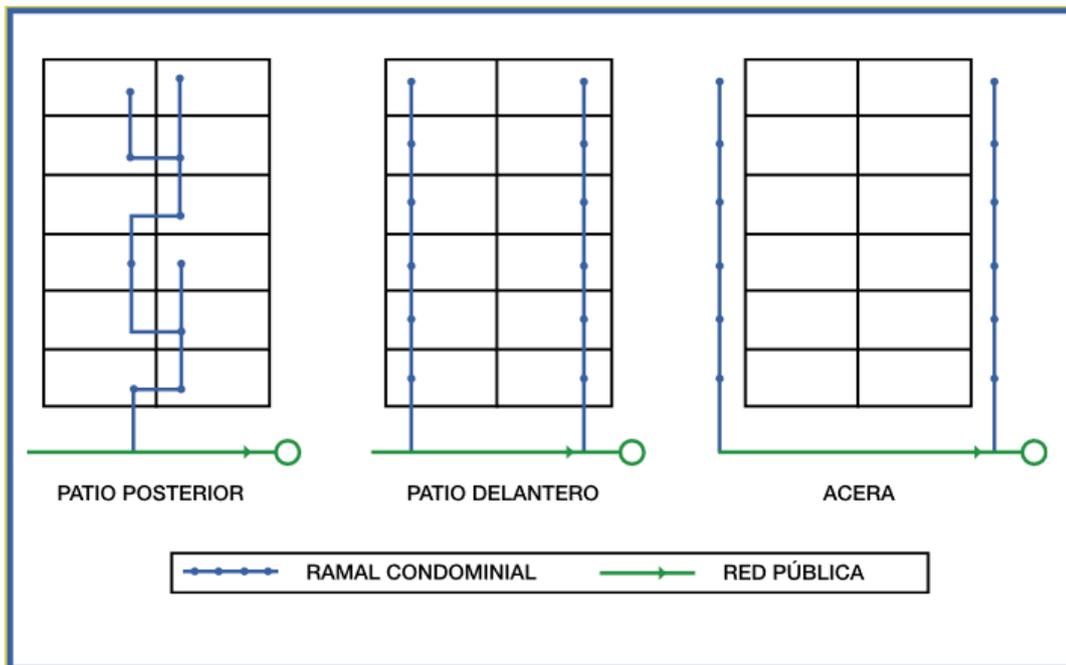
Trazado de los ramales condominiales. Tomado de *sistemas condominiales de alcantarillado y su aplicación en Brasil*. Mello, P. L (1969).
